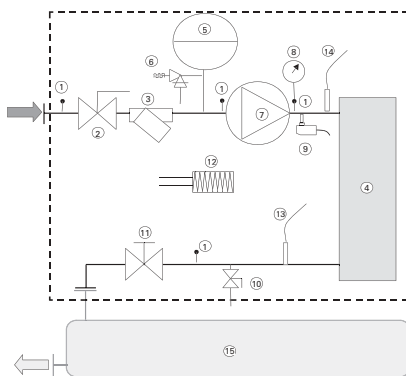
Jednotka bez hydraulického modulu - typický vodní okruh
